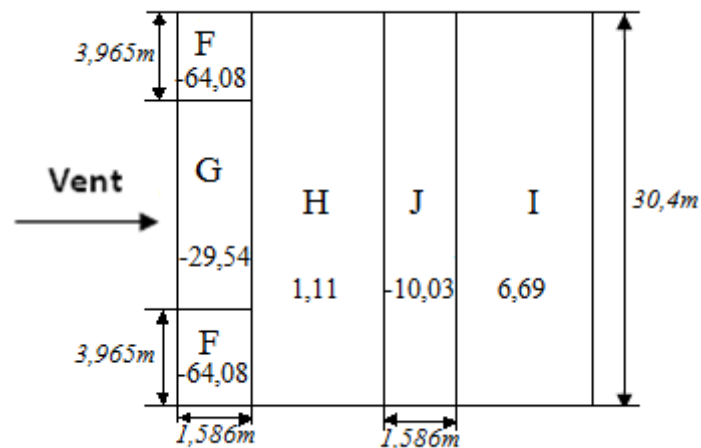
Pression statique du vent q_j sur la toiture (vent sur long pan2)
